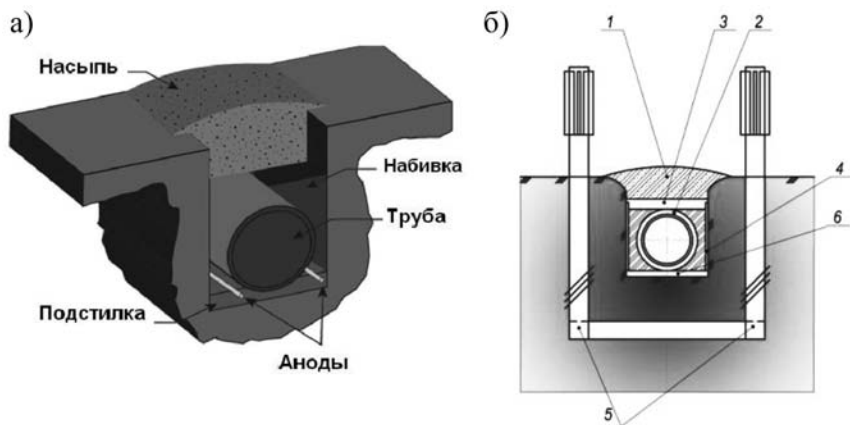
Схема укладки подземного криогенного трубопровода сжиженных газов а, б – схема траншеи трубопровода Тамбей-Бованенково: 1 – насыпь (естественный и привозной грунт), 2 – теплоизоляция (из пенополиуретана), 3 – теплоизоляционный слой, 4 – набивка, 5 – винтовая термосваля, 6 – настил (песок)
